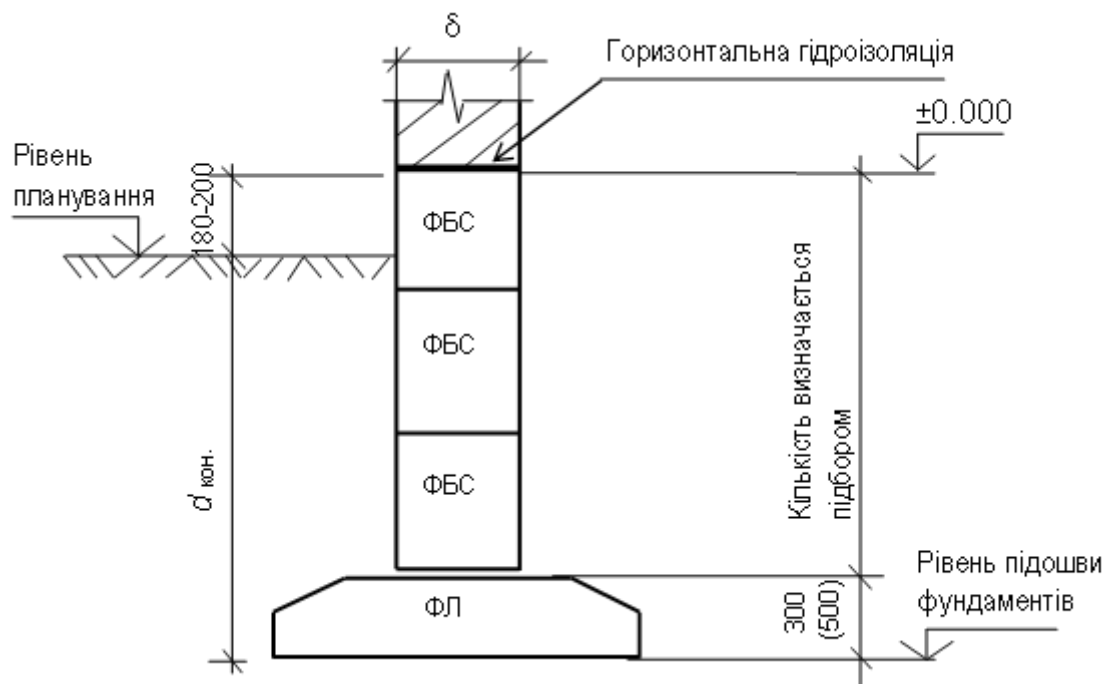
Попереднє конструювання стрічкового фундаменту (збірний, без підвалу)
